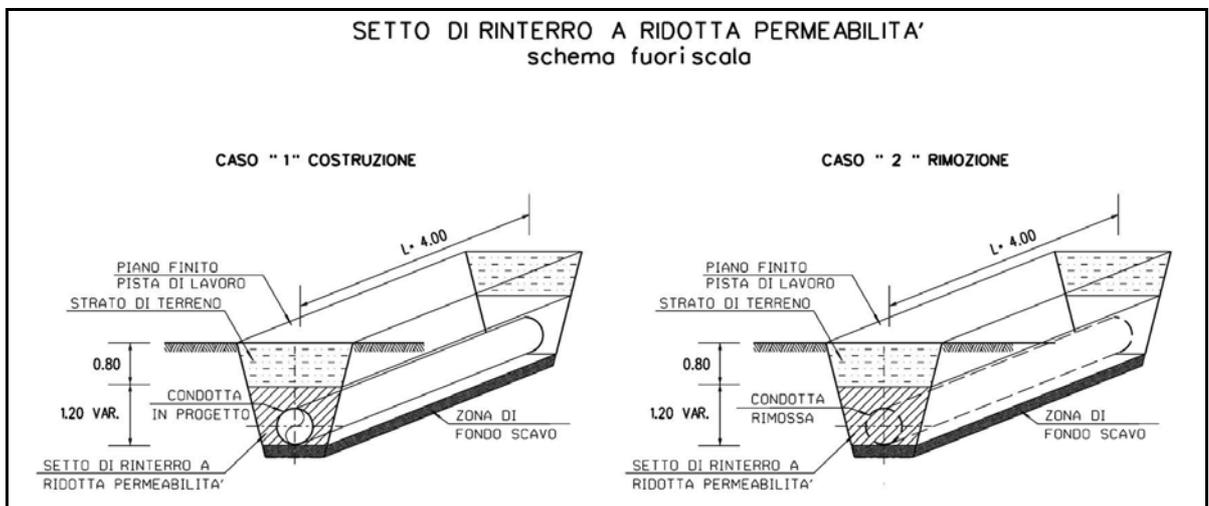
A – Sezione schematica setto a bassa permeabilità
